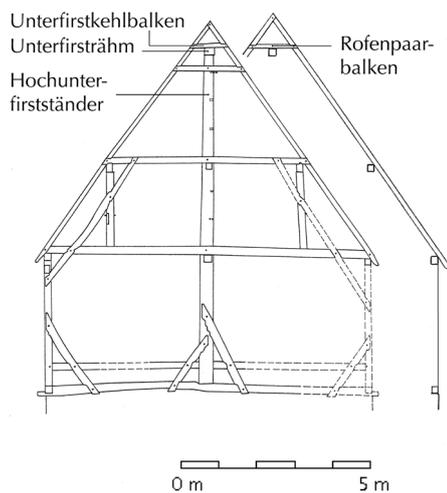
Hochunterfirstständergerüst mit zweifach stehendem Querbund (hier: zweifach stehender Stuhl) im 1. Dachgeschoss und Rofenpaaren zwischen den Querbänden. Stuttgart-Vaihingen, Pfarrhausstr. 17a, 1534 (d).
